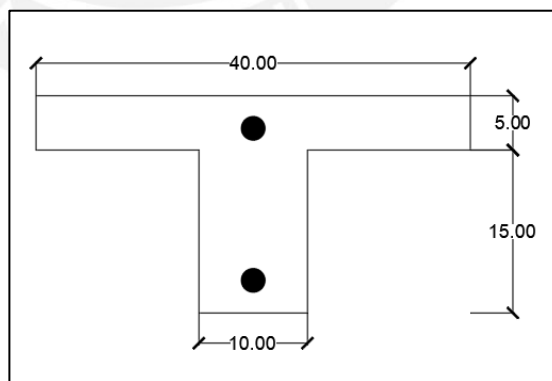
Sección típica de vigueta (Dimensiones en cm.).
